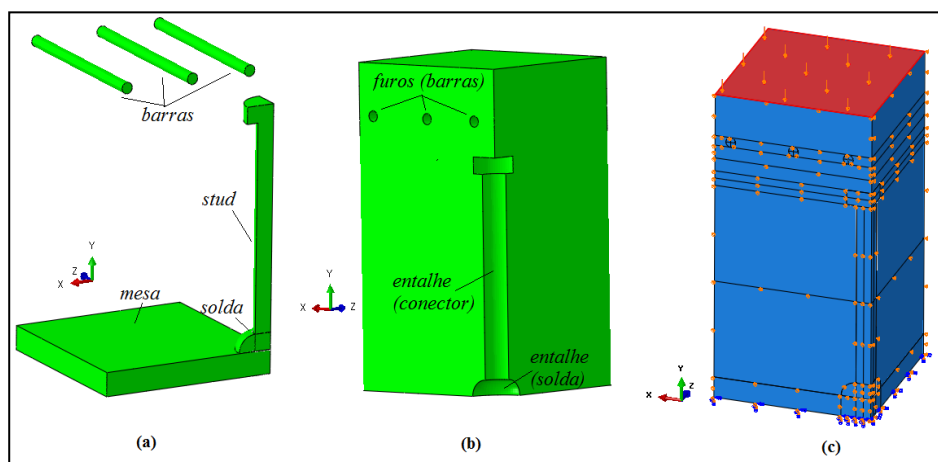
(a) Partes metálicas da estrutura mista, (b) concreto (c) Arranjo dos elementos, condições de contorno e carregamento
